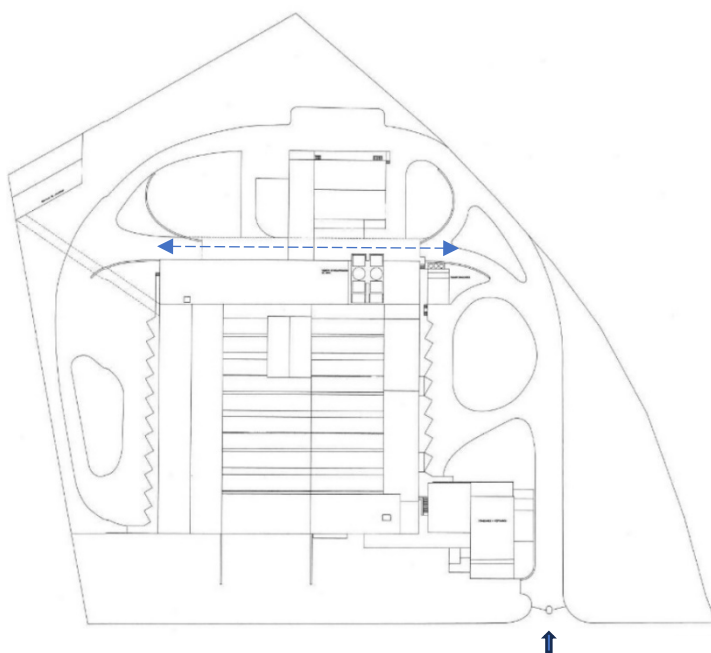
Planta de circulaciones exteriores. Señalados por autor en azul: entrada única en Avenida Herrera Oria y pasaje en costado sur del bloque principal. Norte hacia abajo. Plano base Fundación A. de la Sota.
